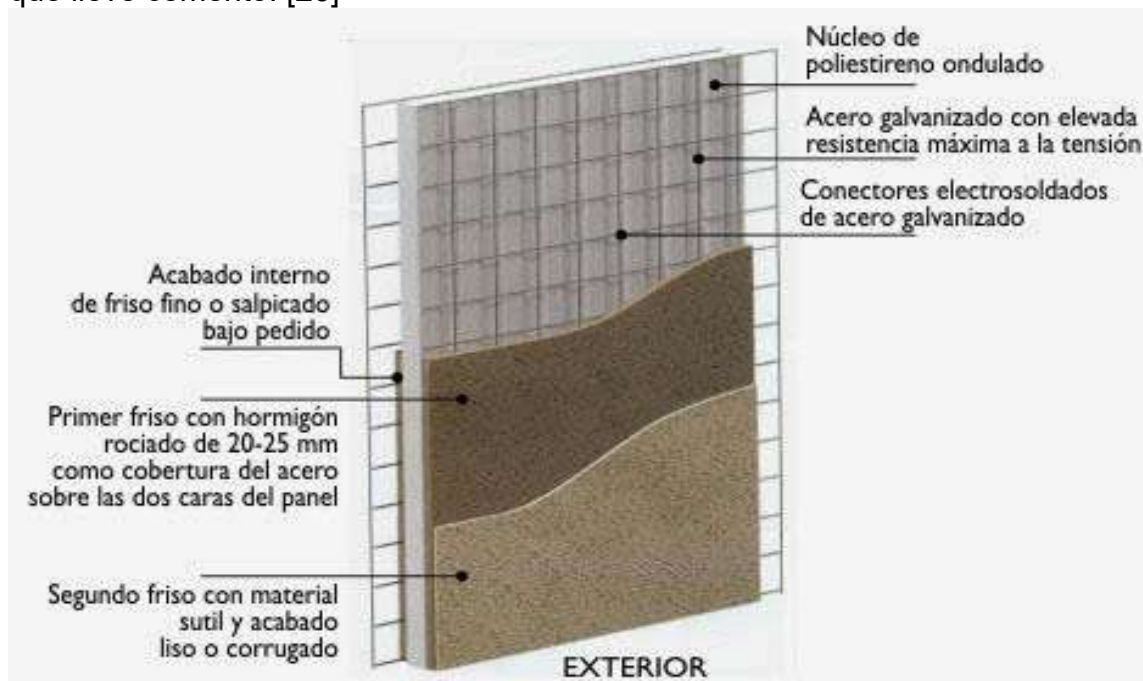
MORTEROS Y CONCRETOS APLICADOS A LOS PANELES
